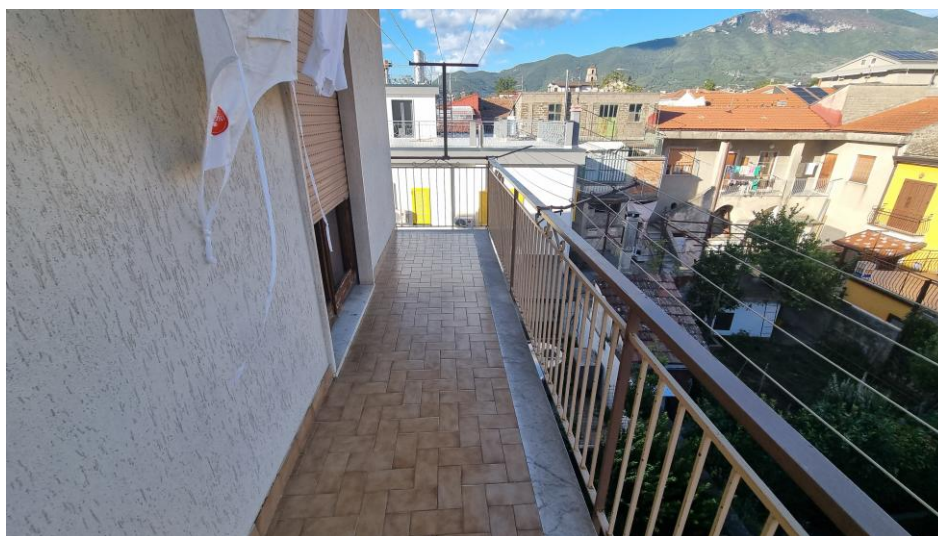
balcone 1 – accesso dalla cucina e/o dalla camera 3
